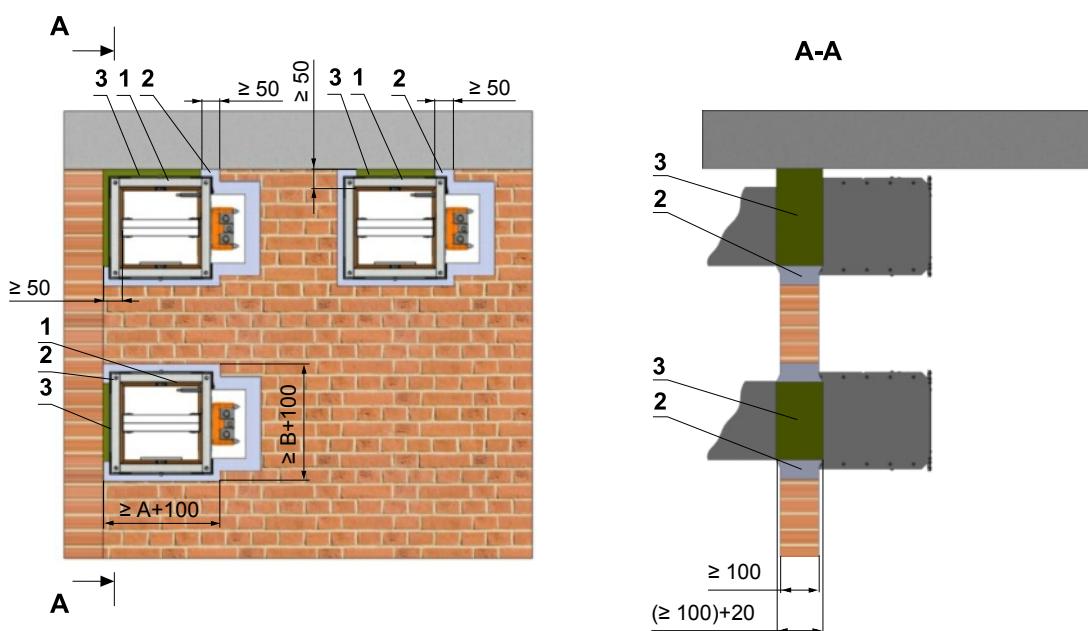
Tuhá stěnová konstrukce - sádra nebo malta
